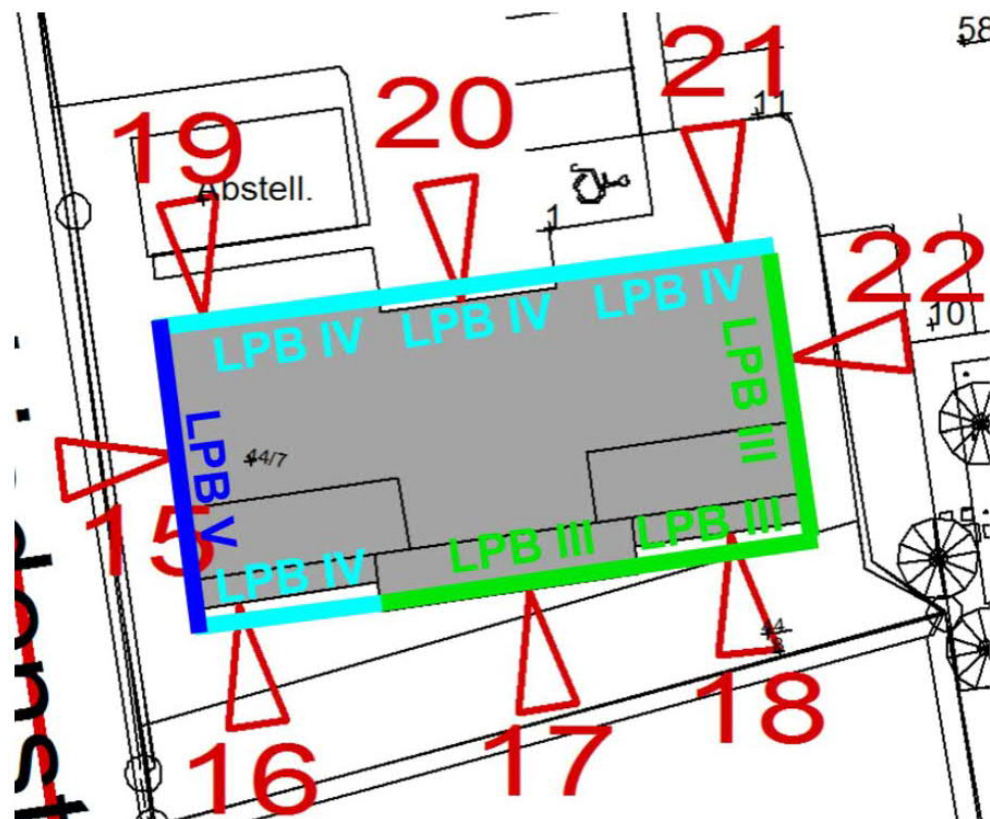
Lageplan der Lärmpegelbereiche im Mischgebiet (geplantes Gebäude)
